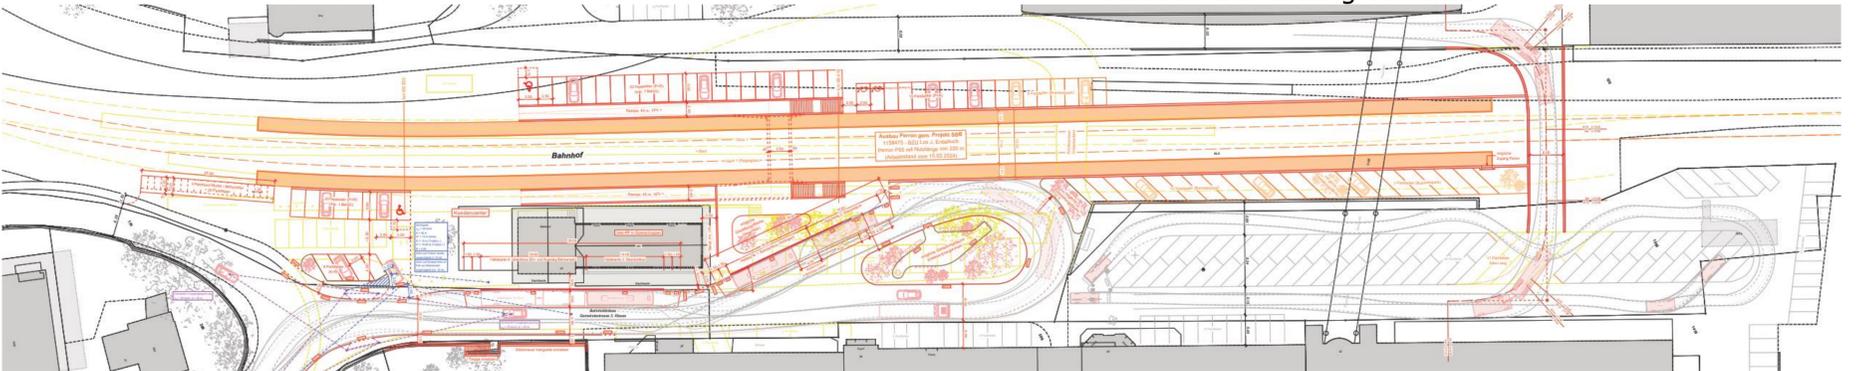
Ausschnitt aus Plan 101 – Situation Bestvariante
